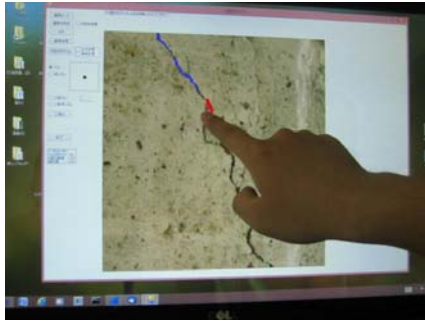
タッチパネルを利用したひび割れ抽出作業
